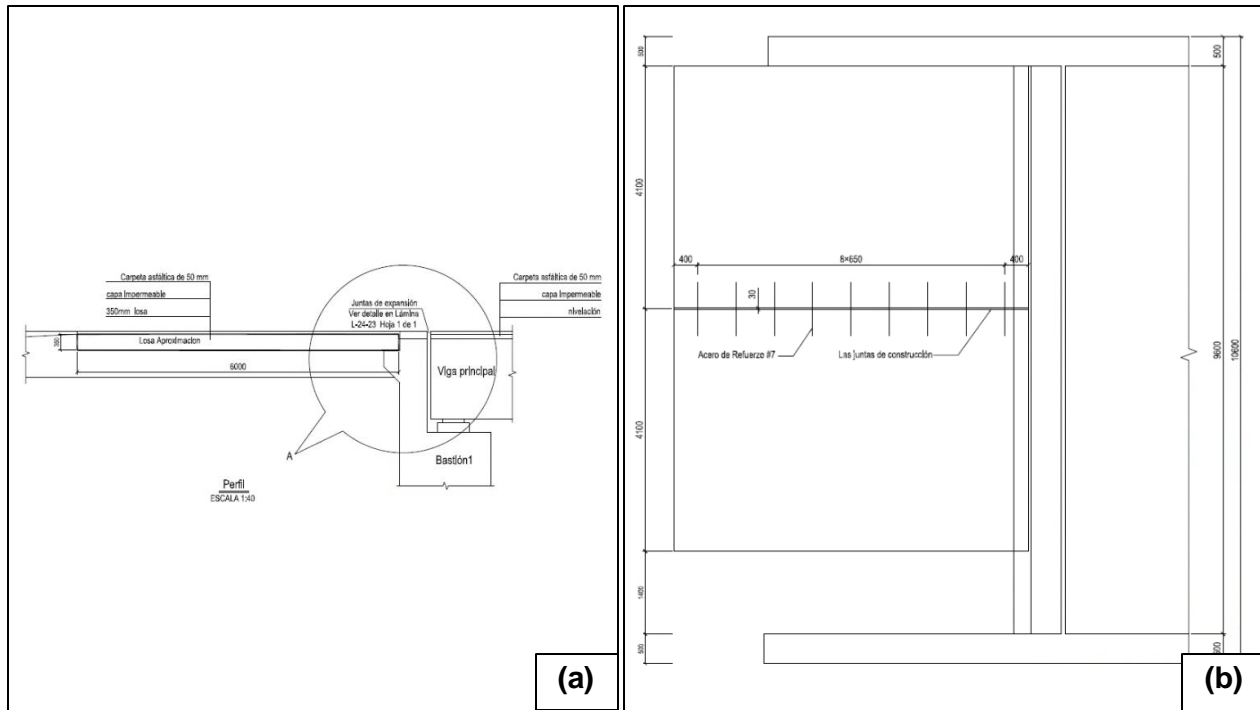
Detalle de la losa de aproximación del puente nuevo sobre la Quebrada Calderón (puente sin sesgo). (a) Vista en elevación. (b) Vista en planta.
